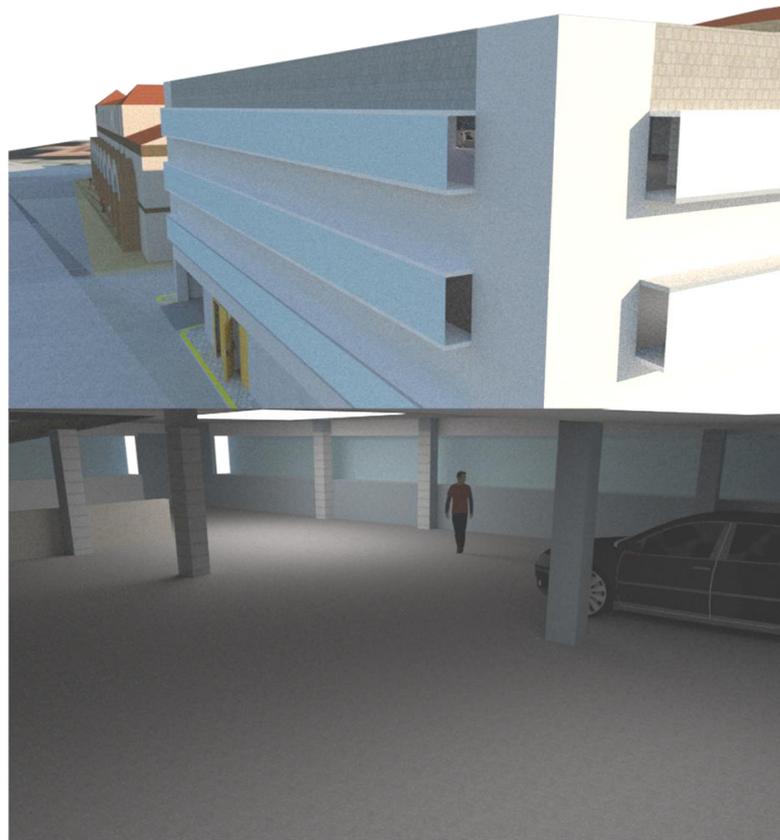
Interior y exterior de una planta tipo (Elaboración propia)
